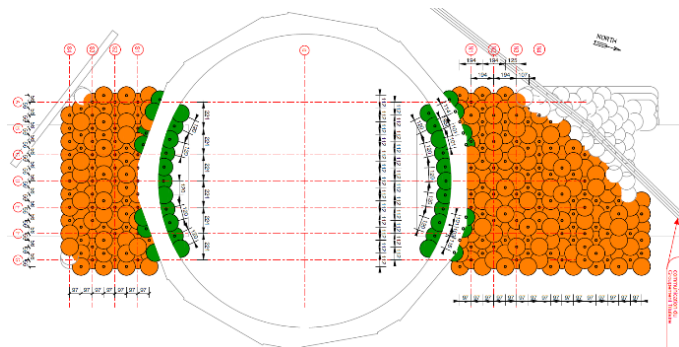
Vue en plan du traitement en jet + colonnes vertes (OA 401P) – Webuild-NGE GC
